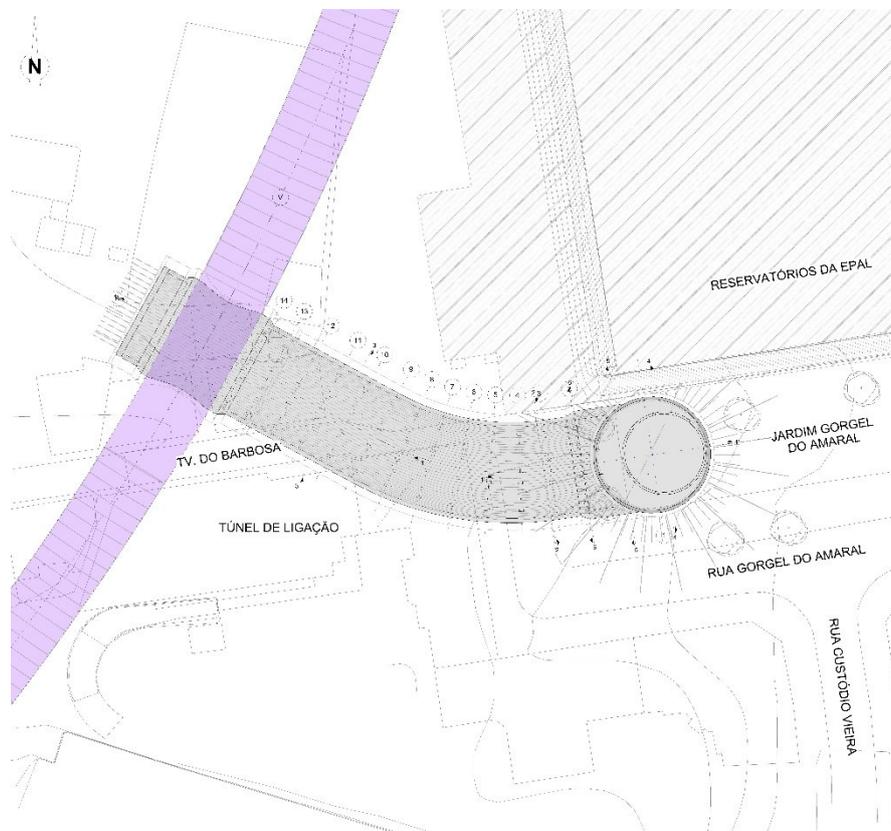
Implantação do PV211 e do respetivo túnel de ligação.
